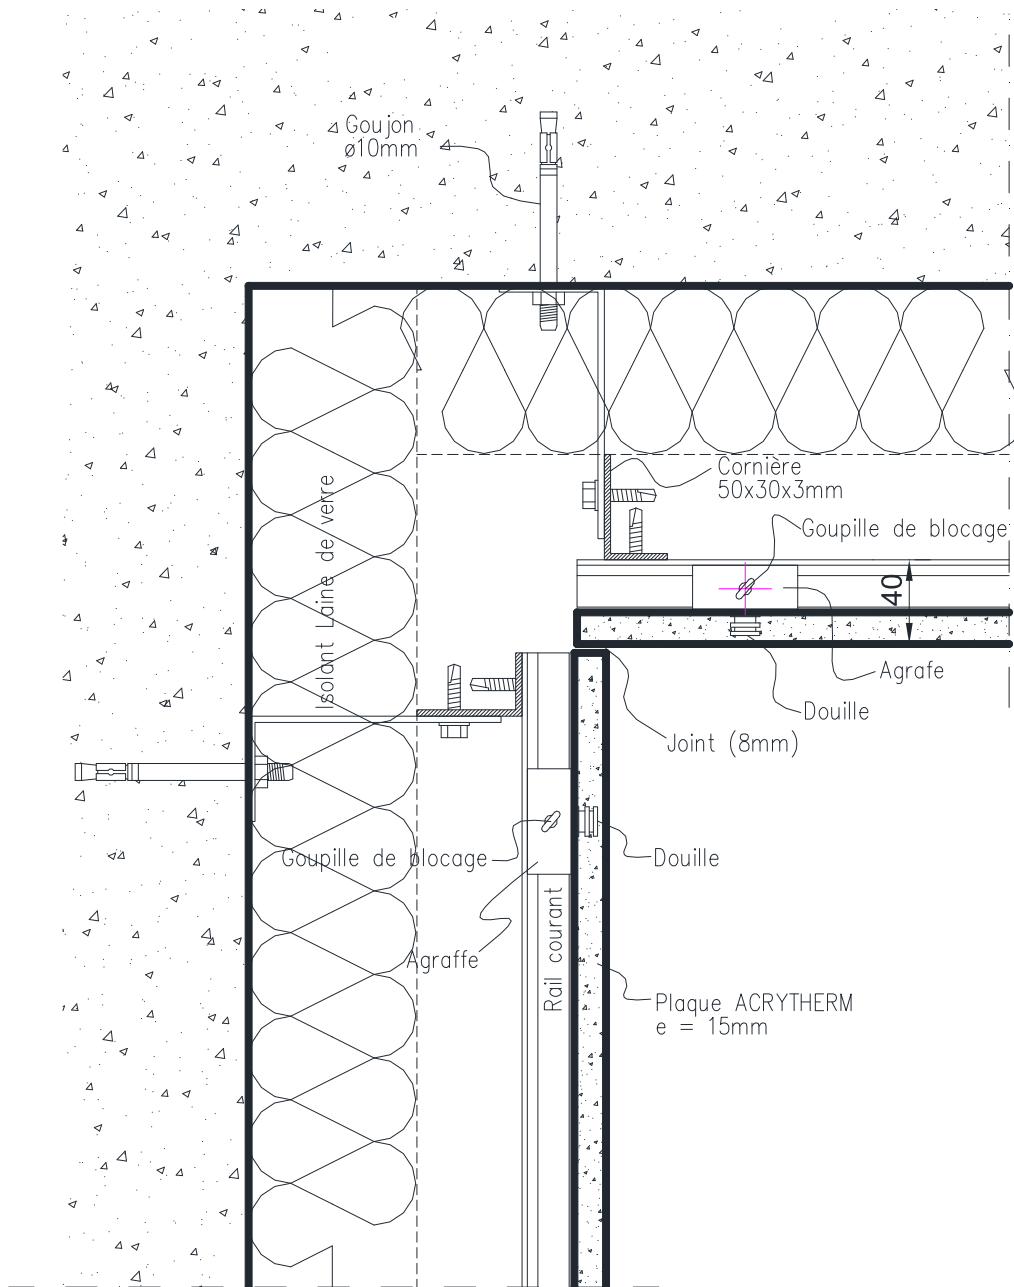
Coupe horizontale en angle haut du panneau – Angle rentrant
